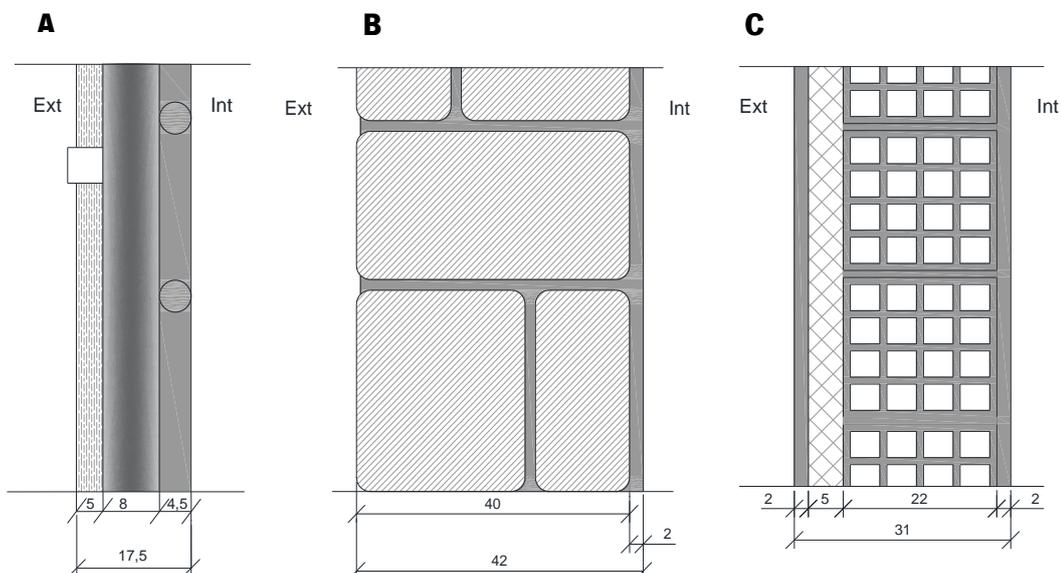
Pormenores construtivos da Parede da Carrasqueira (A), Parede de Alvenaria de Pedra (B) e Parede com sistema ETICS (C)
